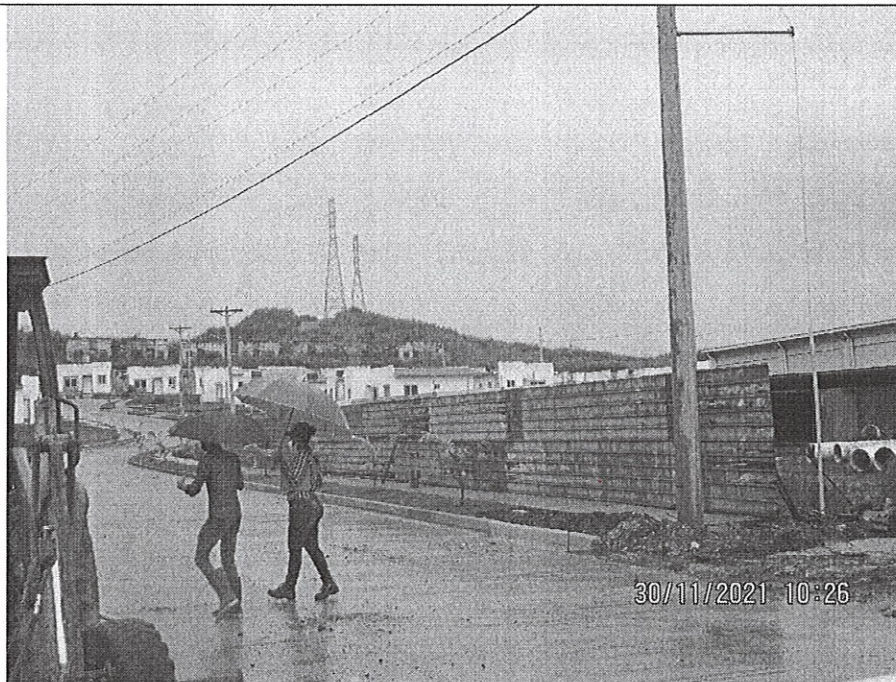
Calle principal de acceso al proyecto, propuesta dentro de la solicitud de modificación. Como se observa en la foto, ya se encuentra desviada.
